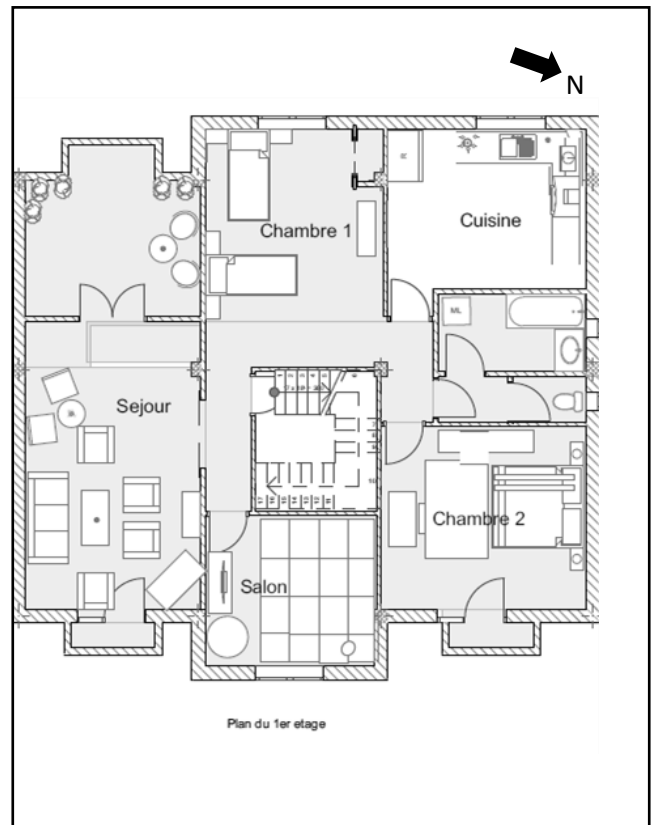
plan 1er étage ech 02 (source : auteur)
